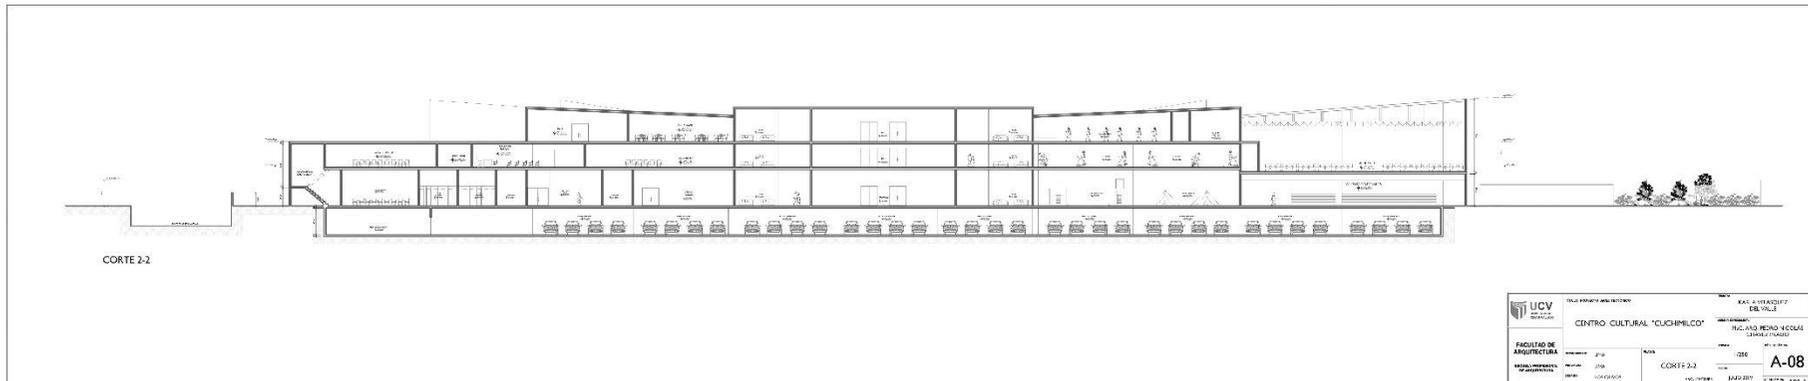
Plano de Arquitectura Corte 2-2. Elaboración propia
